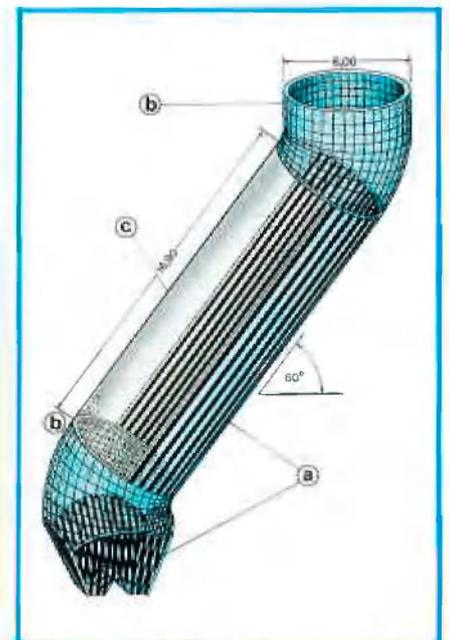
Ausbau-Phasen des Schrägbunkers (für die Aufnahme wurden die Bohlen verschoben)
